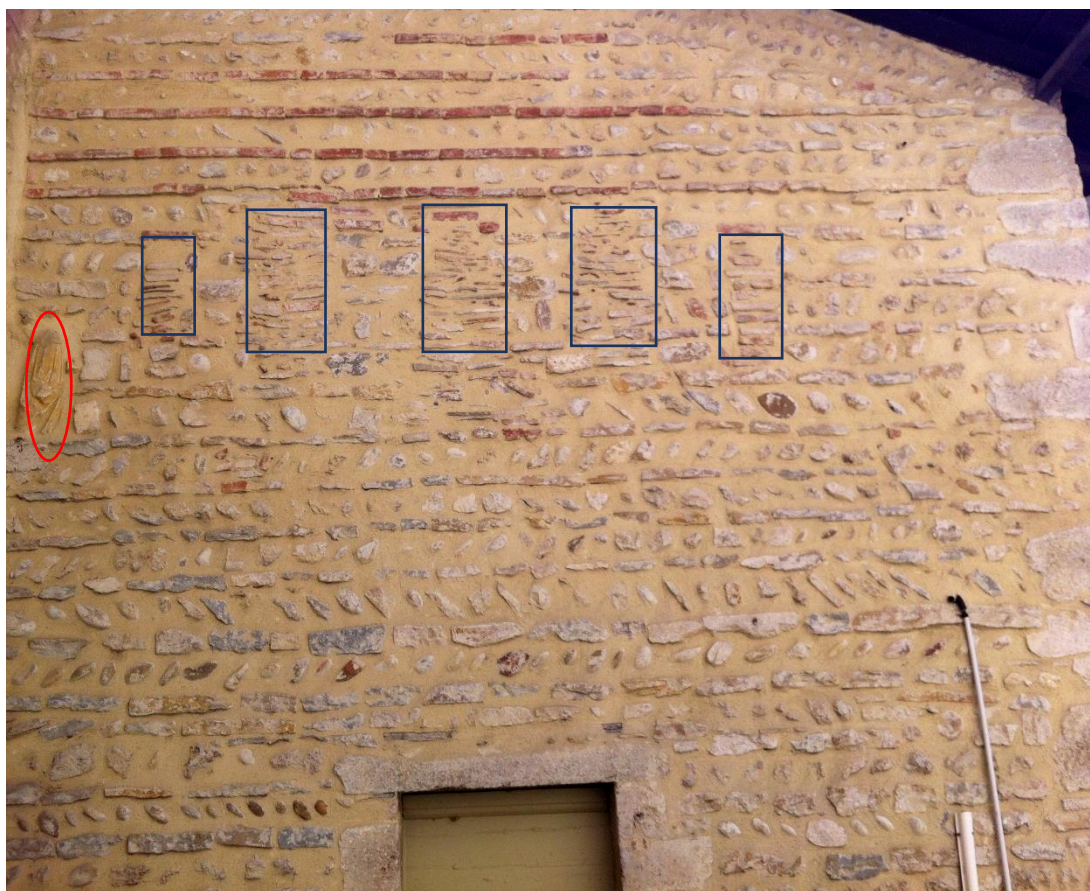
La Boisse : le prieuré : photographies et plan cadastral
